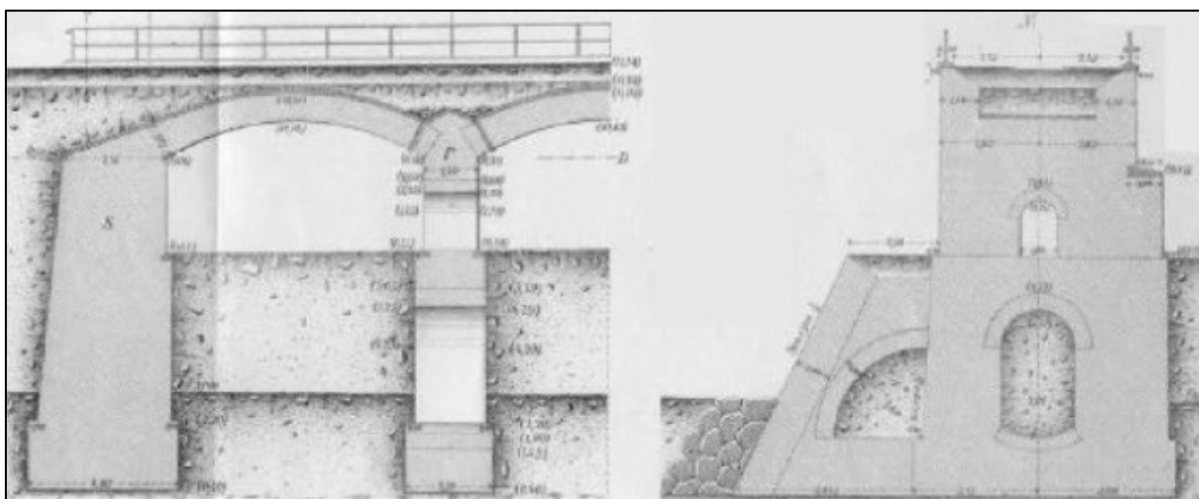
Sezione longitudinale e trasversale di fondazione diretta. (Fonte: Solazzo, 2016)
